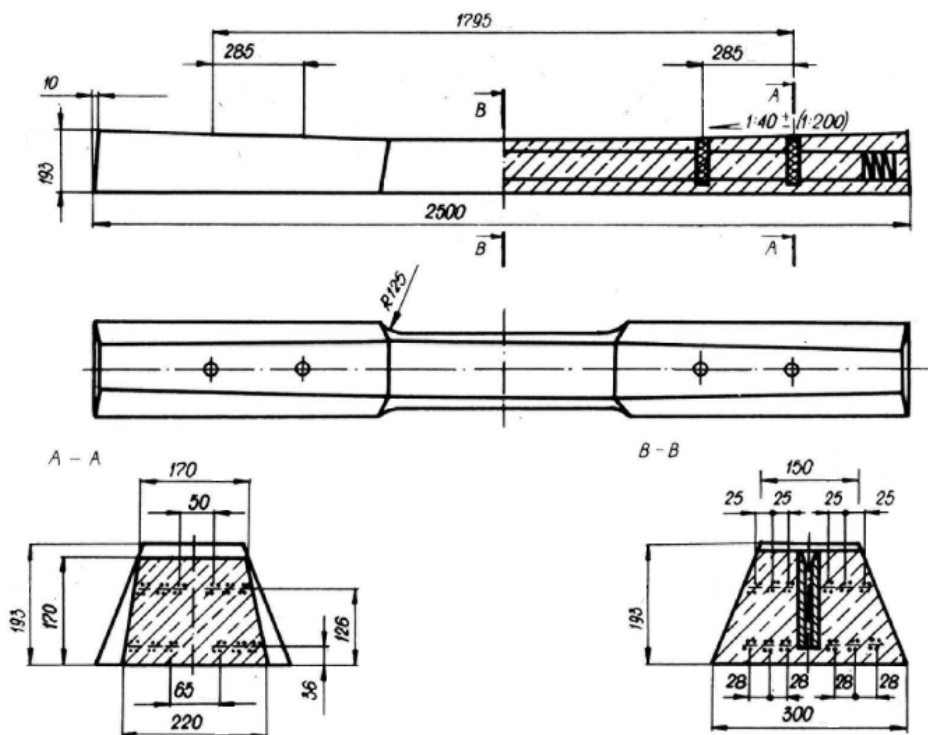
Podkład strunobetonowy typu INBK-8 z przytwierdzeniem klasycznym.
